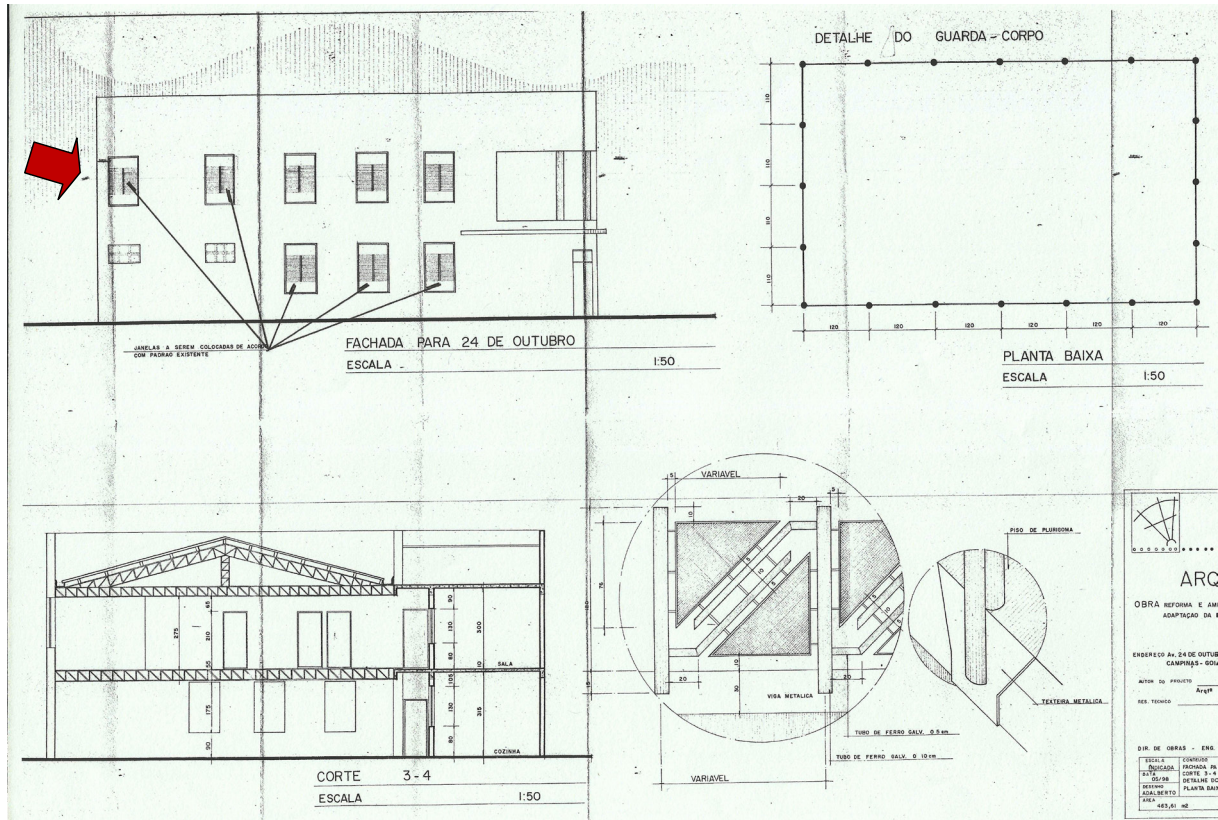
Corte e Fachada Sul pela 24 de Outubro, Hotel de Campinas.
